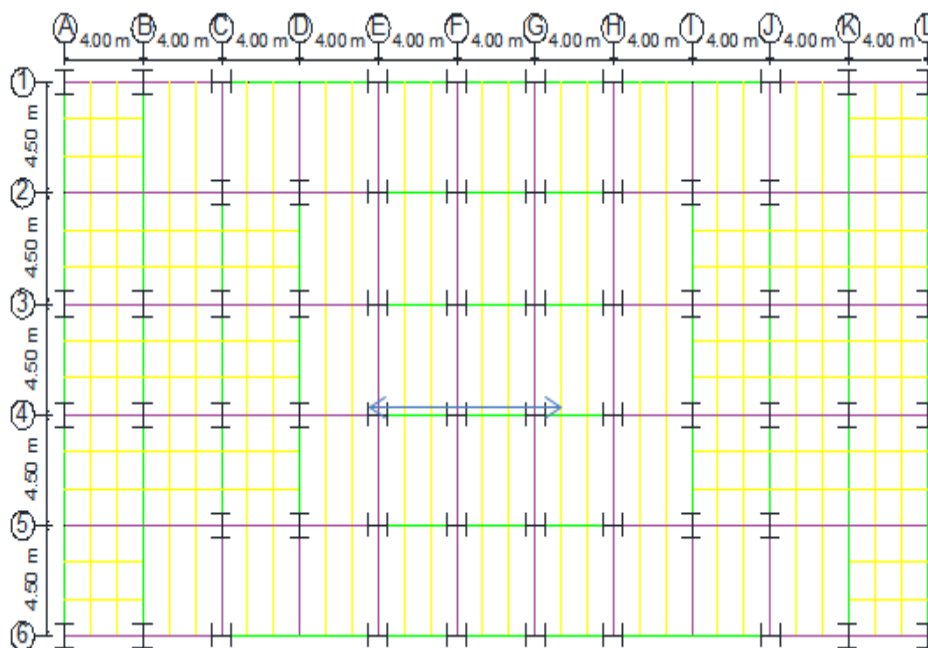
Planta de techo de la edificación con panel Vierendeel 2m.
